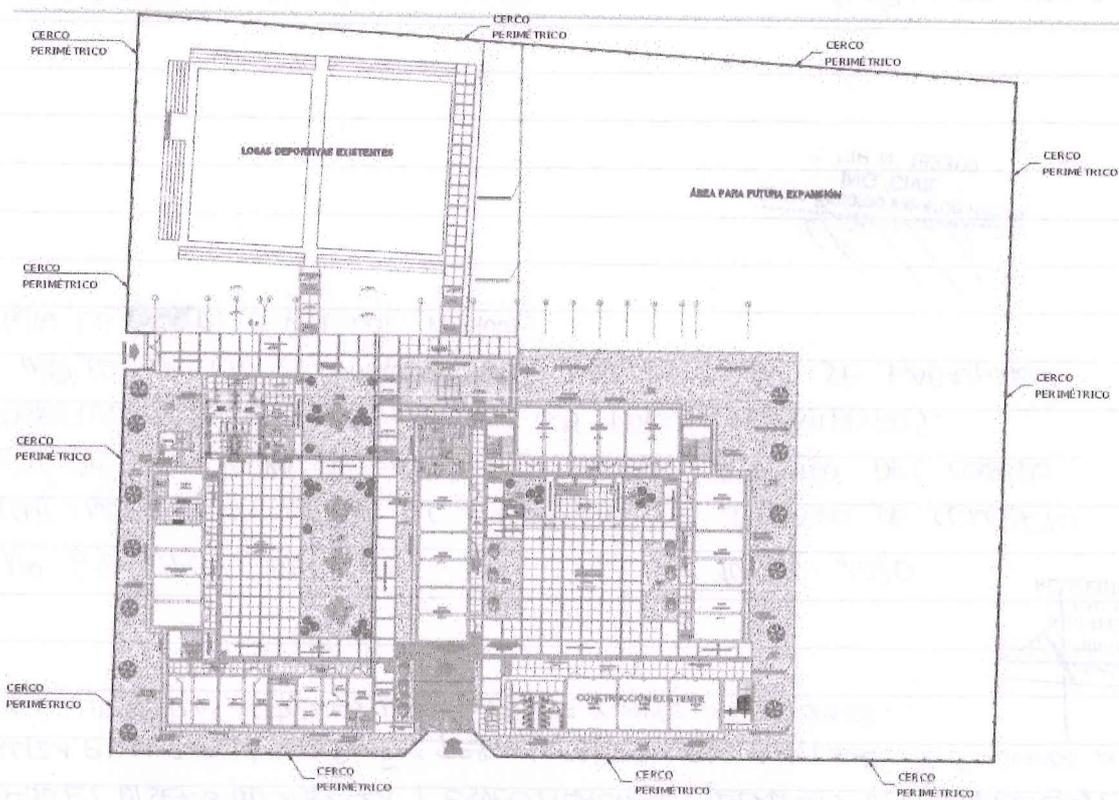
Vista en planta de la I.E. N° 81032 en donde se aprecia de color azul la proyección de cerco perimétrico.
